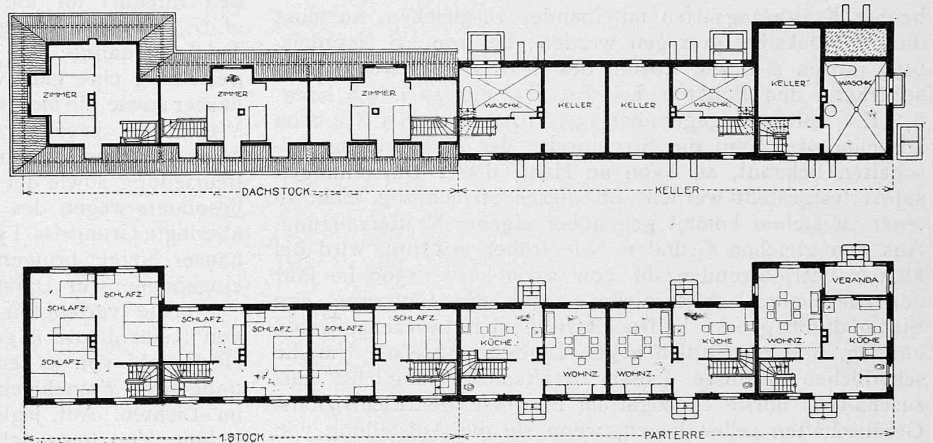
Grundrisse der Sechshäuser-Gruppe. — Masstab 1:400. — Arch. Kölla & Roth, Wädenswil.
